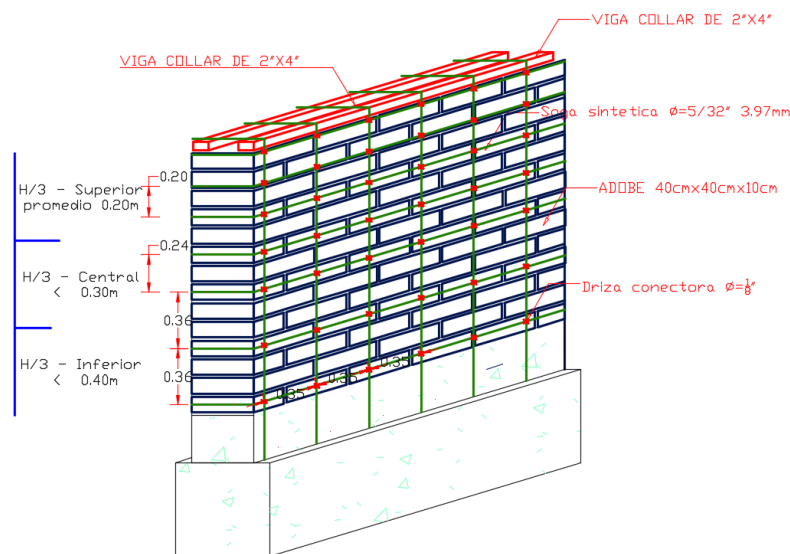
Refuerzo de muro de adobe con malla para tarrajeo
